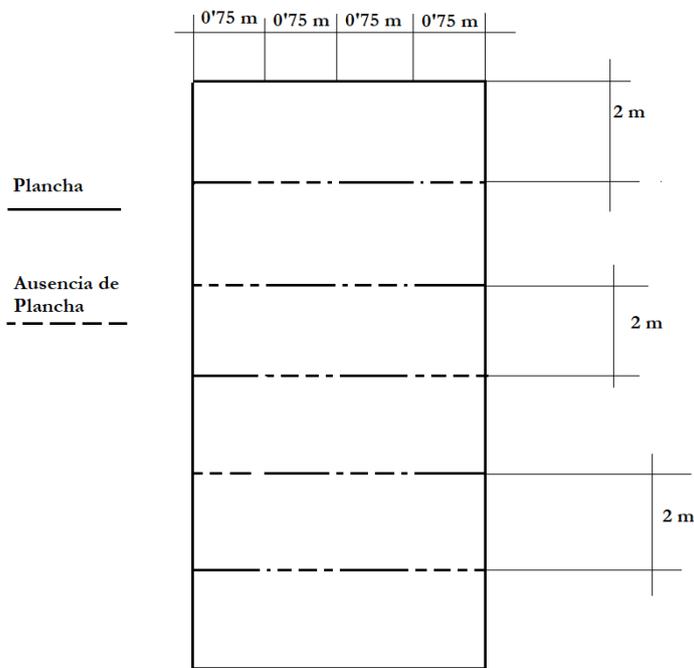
Distribución de las planchas por niveles (cara opuesta distribución opuesta). Vista de perfil.
